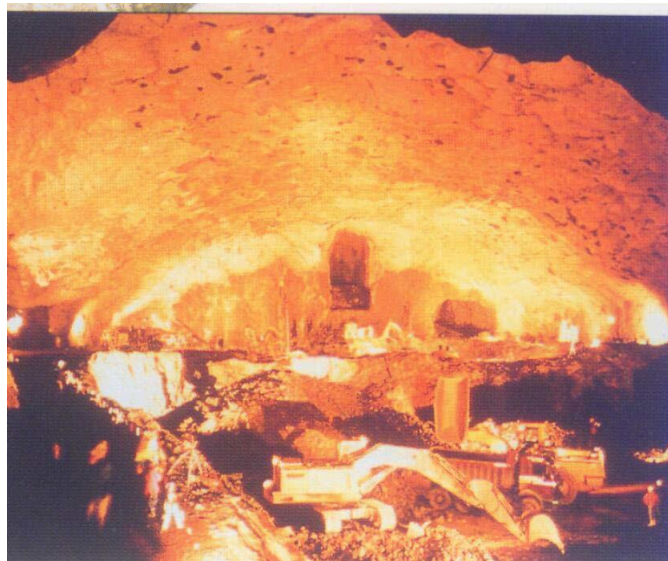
Будівництво льодового стадіону у м. Лілехамері (Норвегія)
